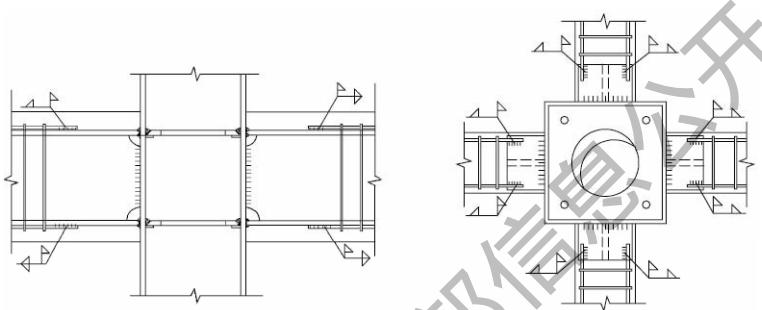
钢筋混凝土梁与矩形钢管混凝土柱焊接牛腿式连接节点示意
